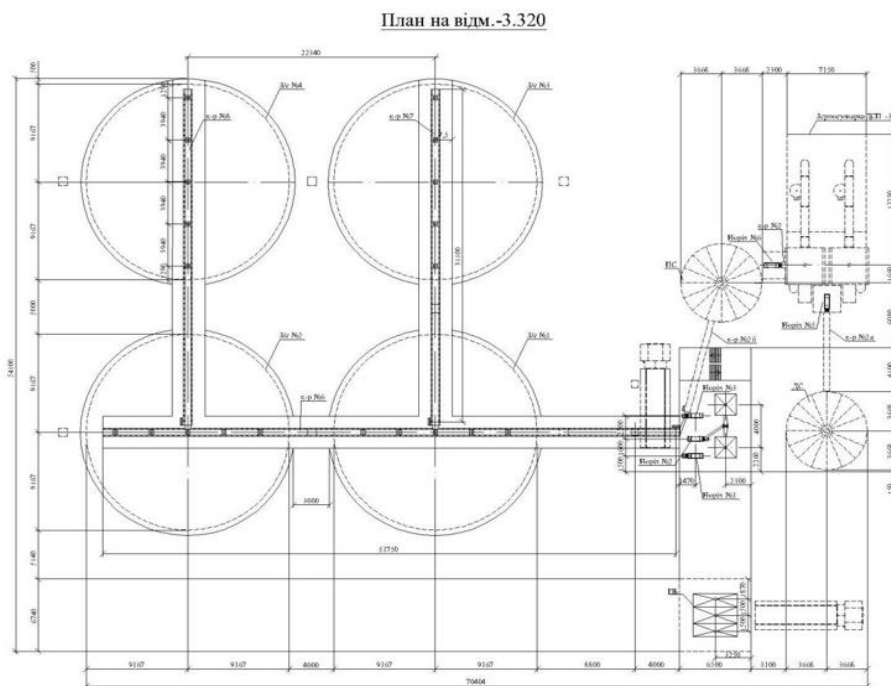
План ув'язування силосів з робочою баштою
